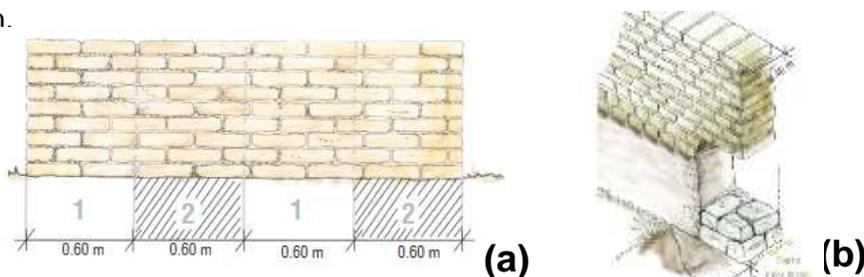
(a)Excavaciones alternadas. (b)Relleno de muros con piedra de la región. Fuente: MVCS, 2014.
